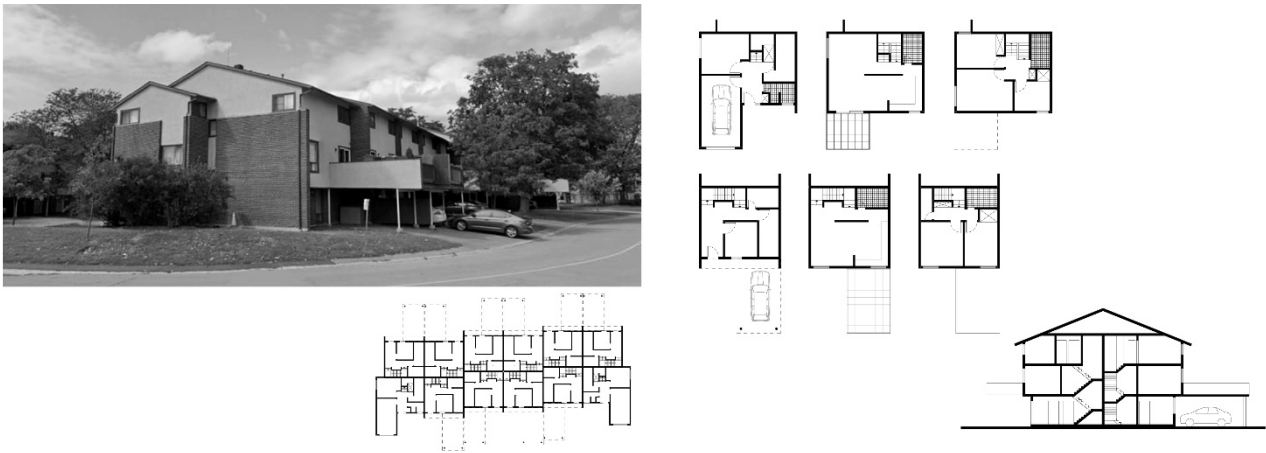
4-рівневий зблокований житловий будинок (Town Homes). Загальний вигляд з боку проїзду, план поверхів, розріз, схема блокування. (Фото [15], креслення– Яблонська Г.Д.)
